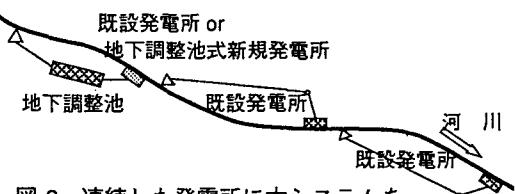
連続した発電所に本システムを適用した場合の概要図(平面図)
